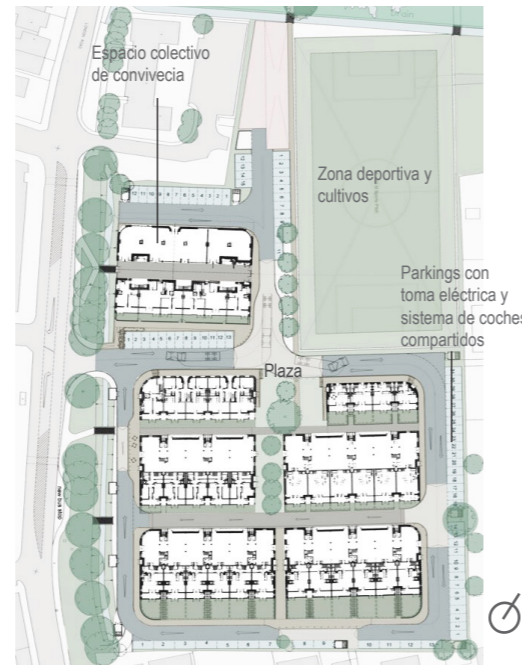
Planta en emplazamiento. Imagen con intervención propia.
